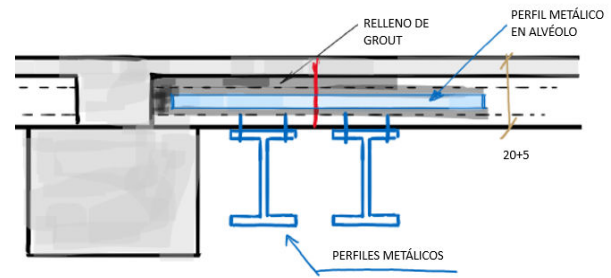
Esquema de sección de posible refuerzo de la zona afectada por la fisura
